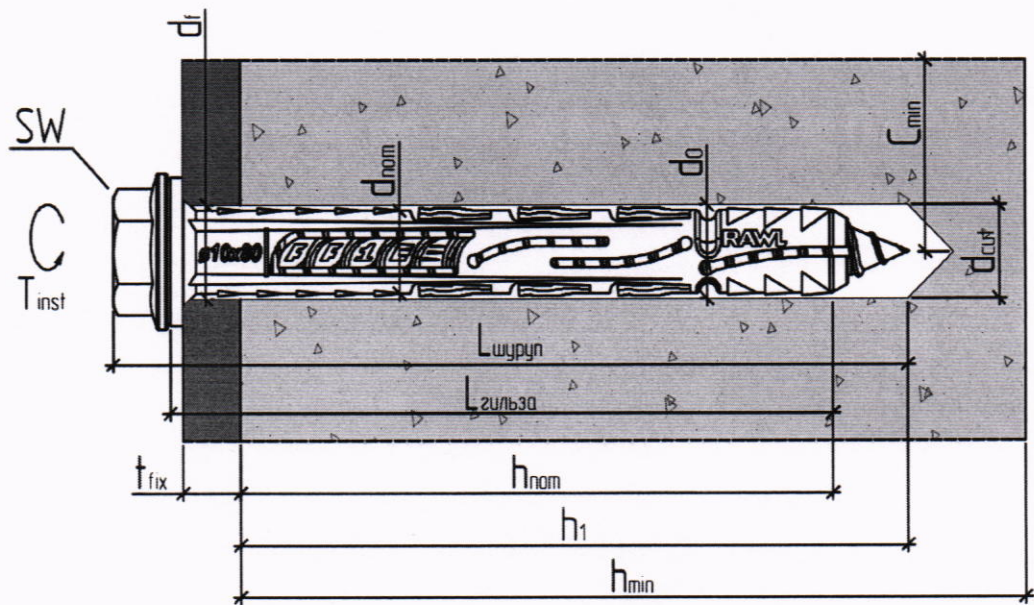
Установка дюбеля RAWLPLUG типа FF1
